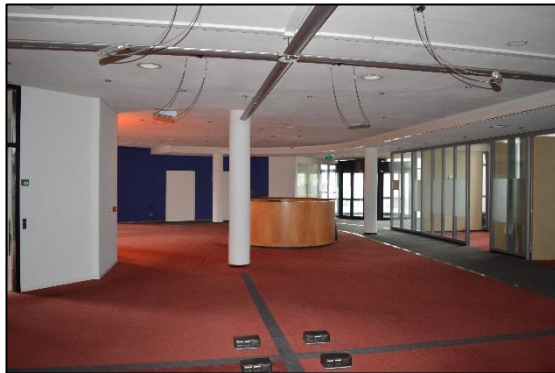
Overzichtsfoto noordzijde van pand.
